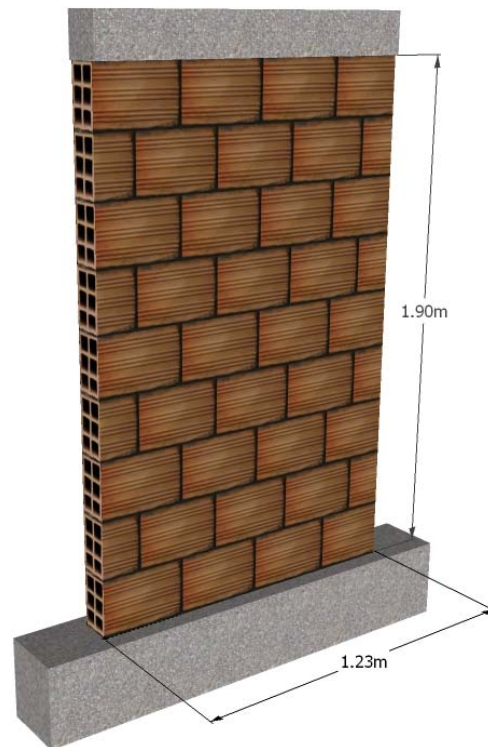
Modelado 3D del muro corto sin reforzamiento. Fuente: El autor
